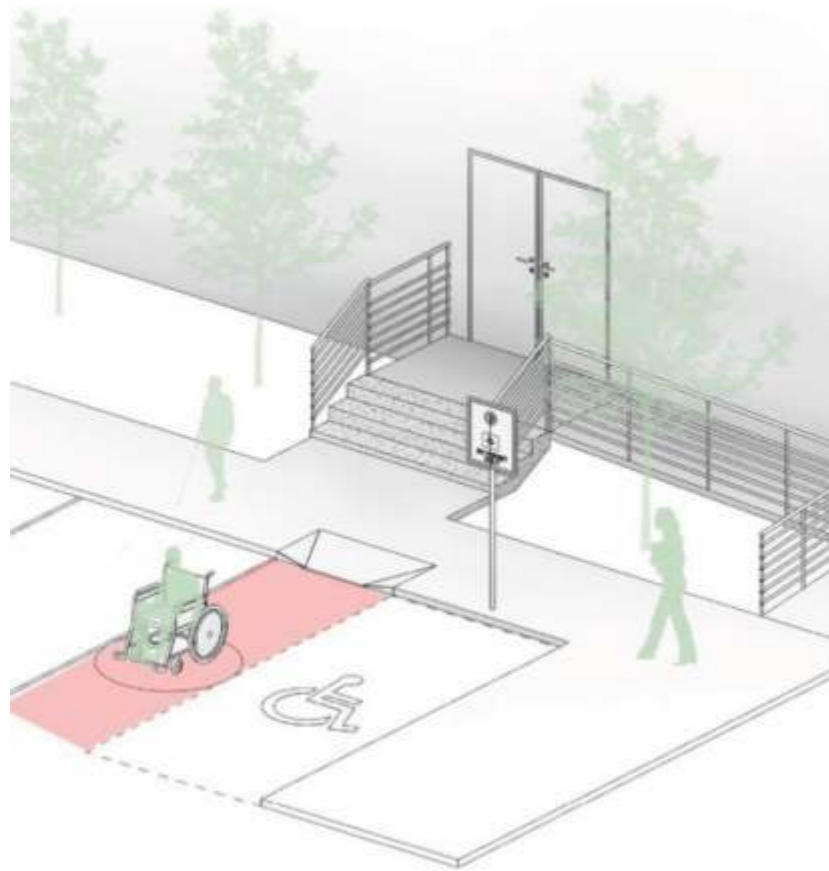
Paraqitje tridimensionale e një vendparkingu për PAK
